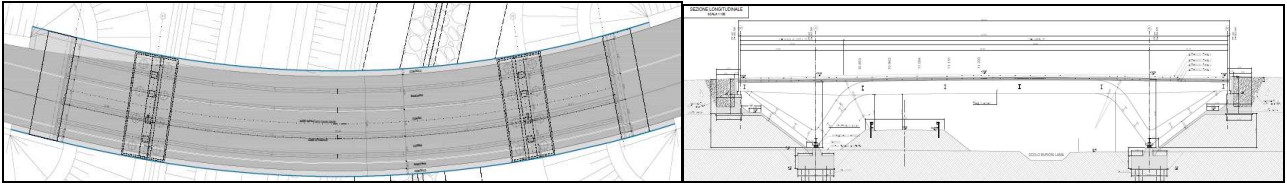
Pianta Cavalcavia e Sezione longitudinale Strada Comune della Braglia
